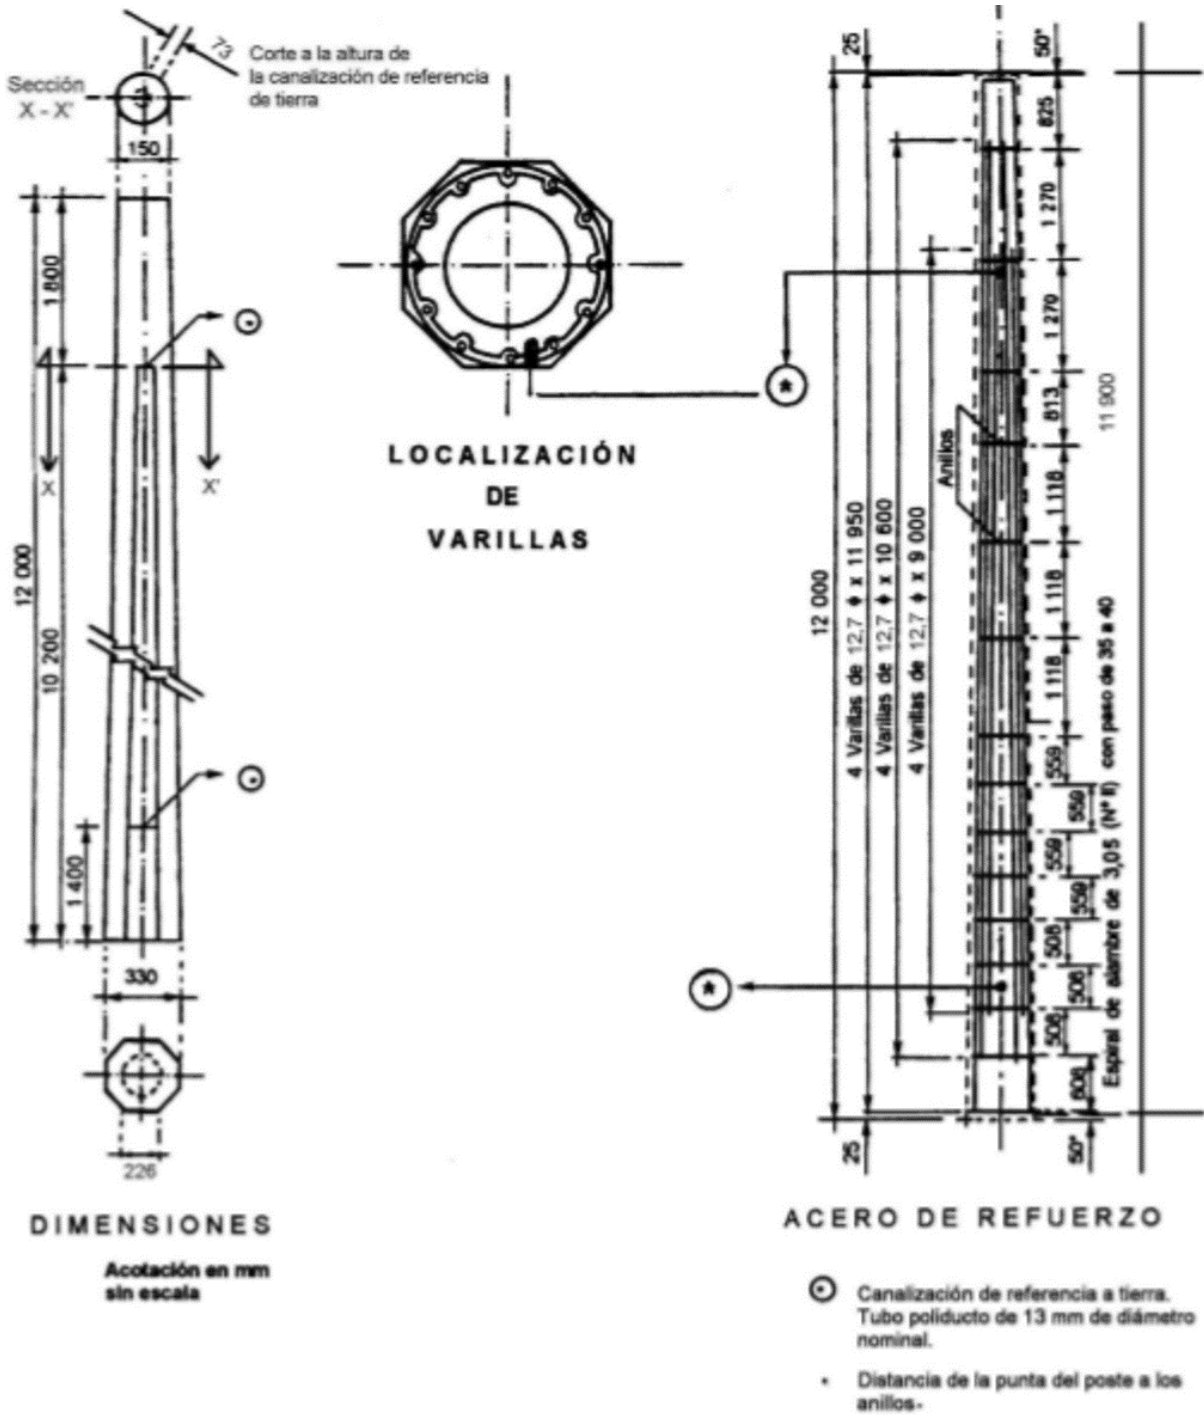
Planos de especificación para postes de concreto reforzado PCR- 12C-750 de 12 metros.
